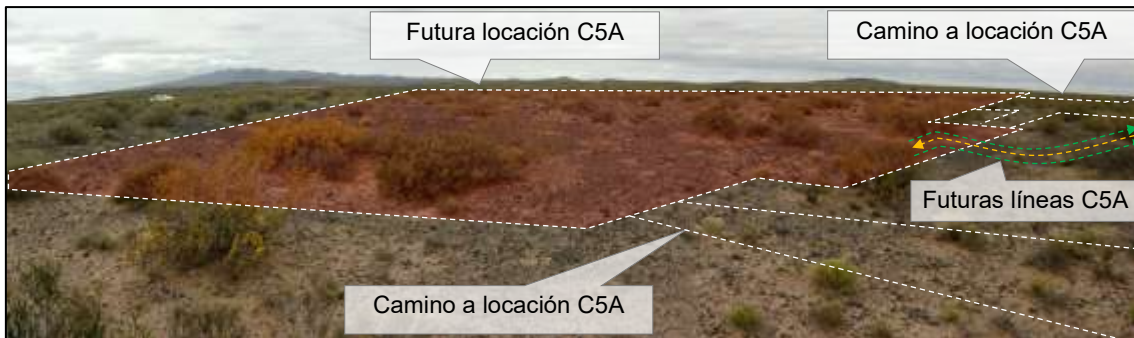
Vista en dirección Sureste. Se representa la futura locación C5A, caminos y las futuras líneas C5A. Coordenadas x: 5833725; y: 2488915.
